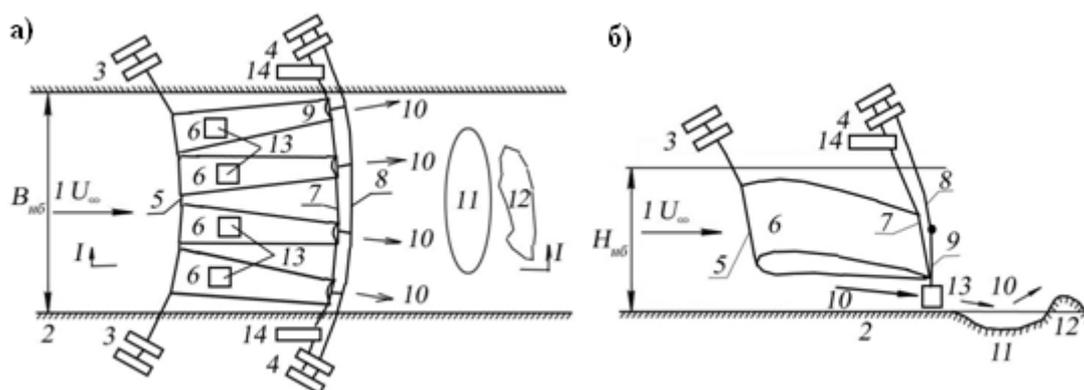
Схема устройства для защиты нижних бьефов гидроузлов от размыва: а – план; б – поперечный разрез; 1 – речной поток; 2 – урез берега; 3 – основные опоры; 4 – береговые опоры; 5 – несущий передний канат; 6 – гибкий профиль; 7 – несущий задний канат; 8 – регулирующий канат; 9 – леер; 10 – руслоформирующий поток; 11 – область размыва; 12 – область русловых отложений; 13 – пригруз; 14 – натяжное устройство
